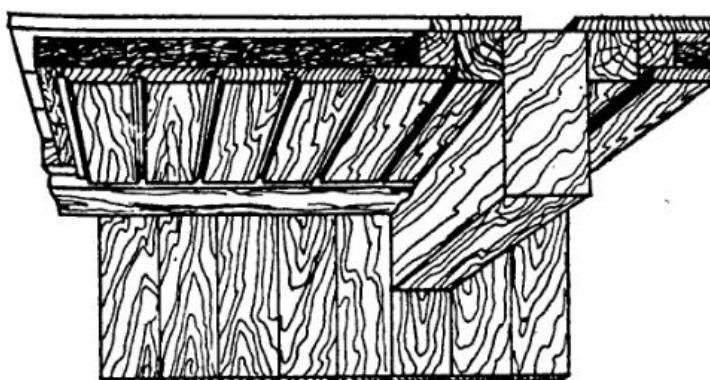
Конструкция перекрытия с открытыми балками.
